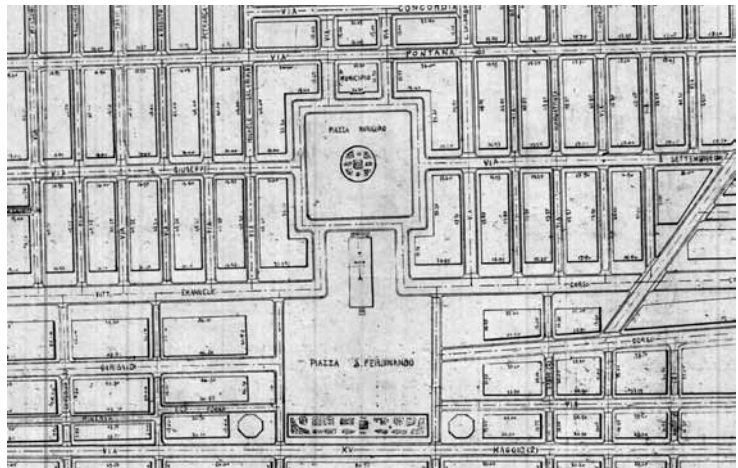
Progetto di sistemazione strade interne, ing. V. Rizzi, Archivio storico.
